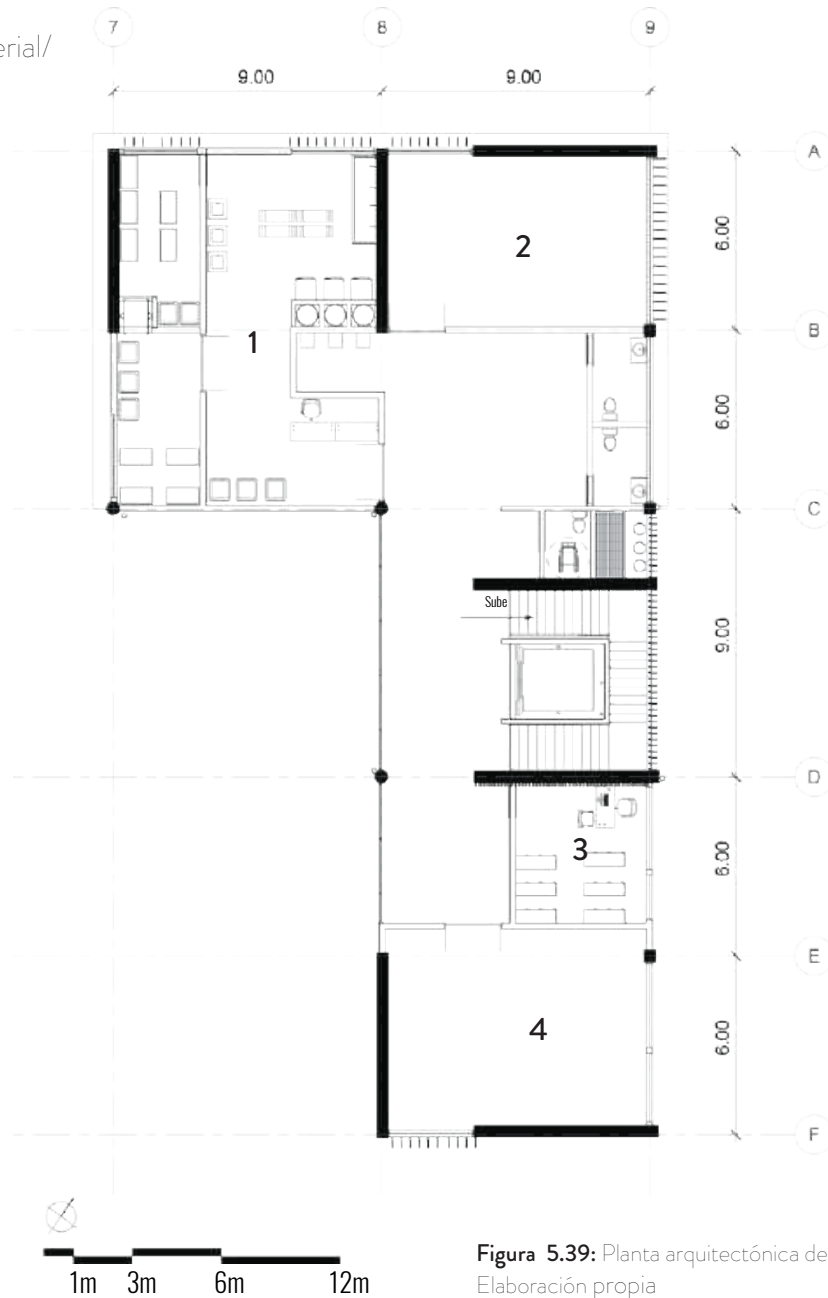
Planta arquitectónica detallada Nivel_L-1
